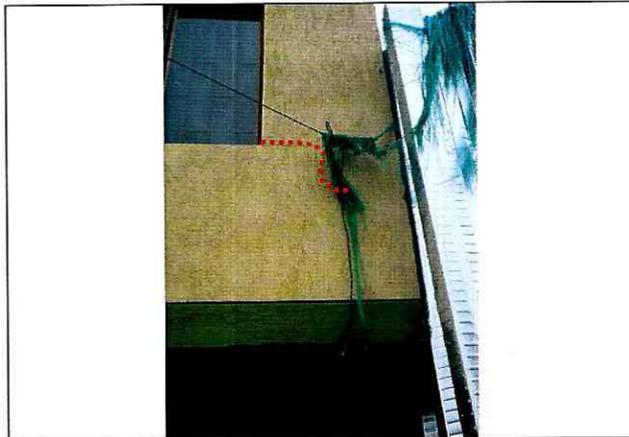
Vista de la separación entre las edificaciones con nomenclatura Calle 163 No 17-24 y Calle 163 No 17-36
